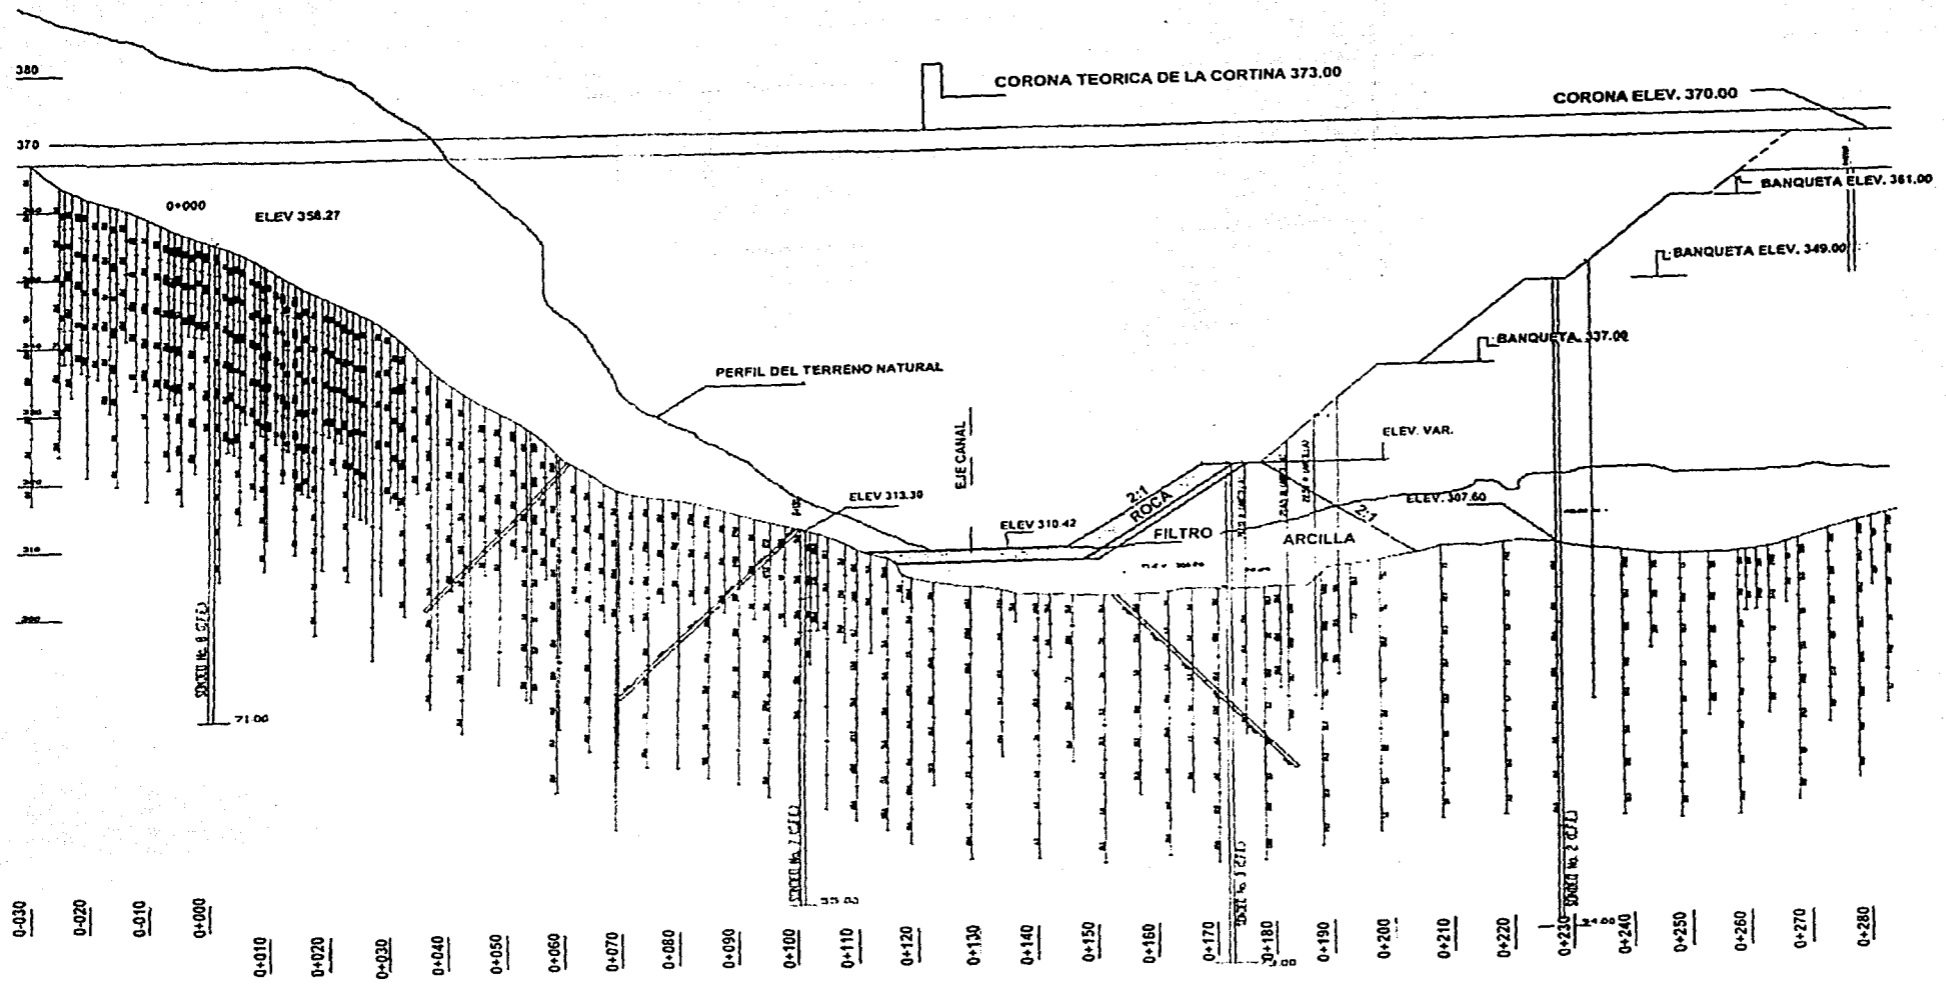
Tratamiento de cimentación. Corte Longitudinal ladera derecha
